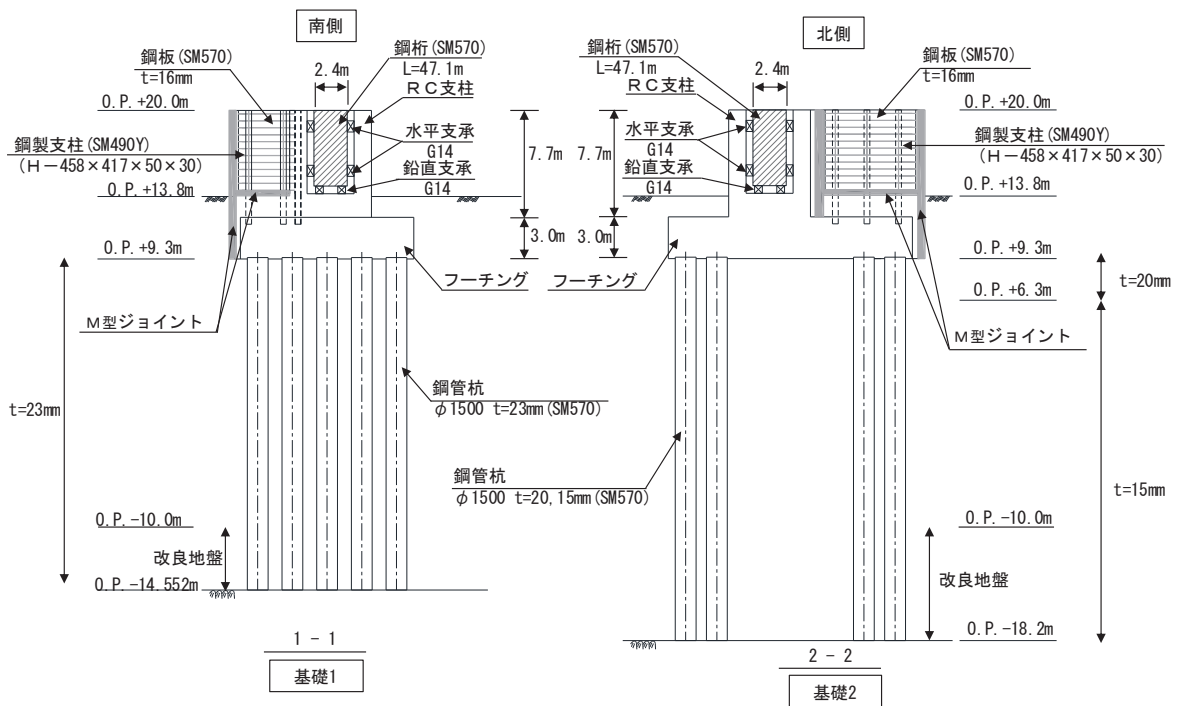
鋼製遮水壁（鋼桁 3） 正面図及び断面図
